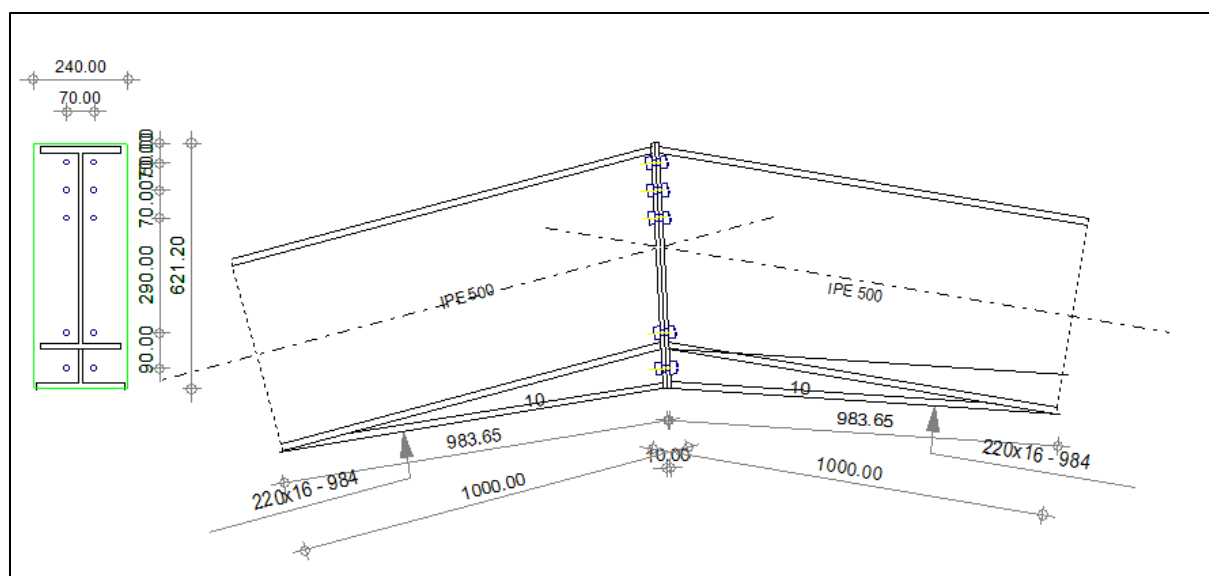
Schéma de l'assemblage poutre-poutre.
